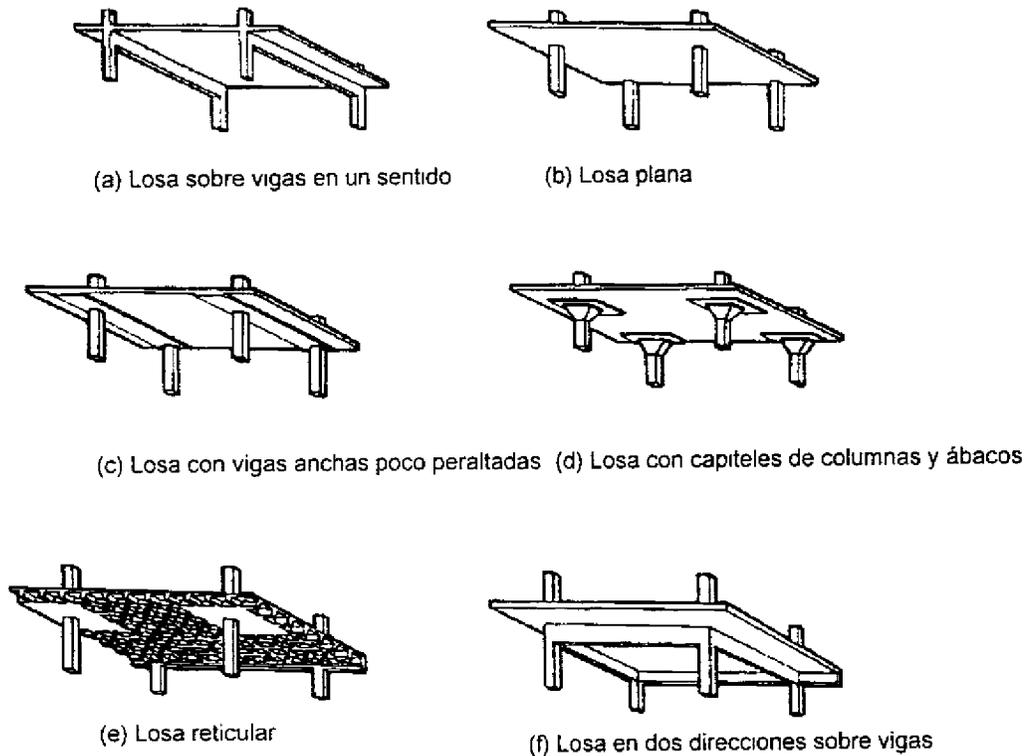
Tipos de losas postensadas (Collins y Mitchell, 1991).
